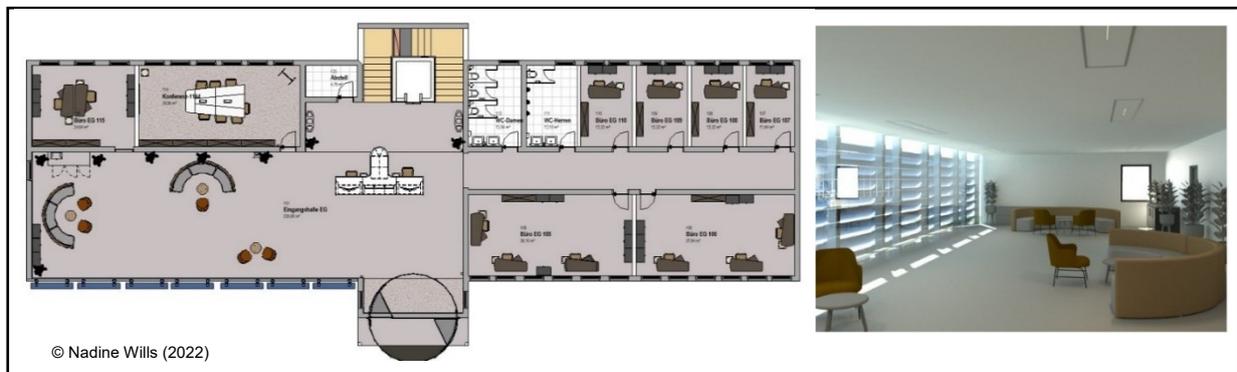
Grundriss EG Evaluierungsgebäude und Darstellung Eingangshalle
